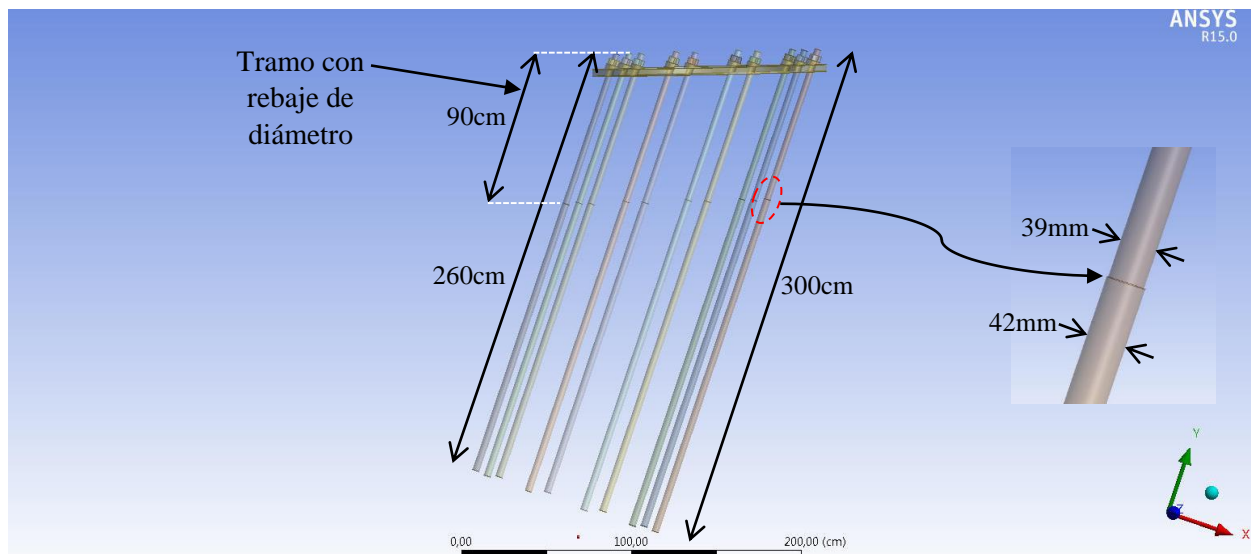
Largo de las barras de anclaje (vista lateral).
